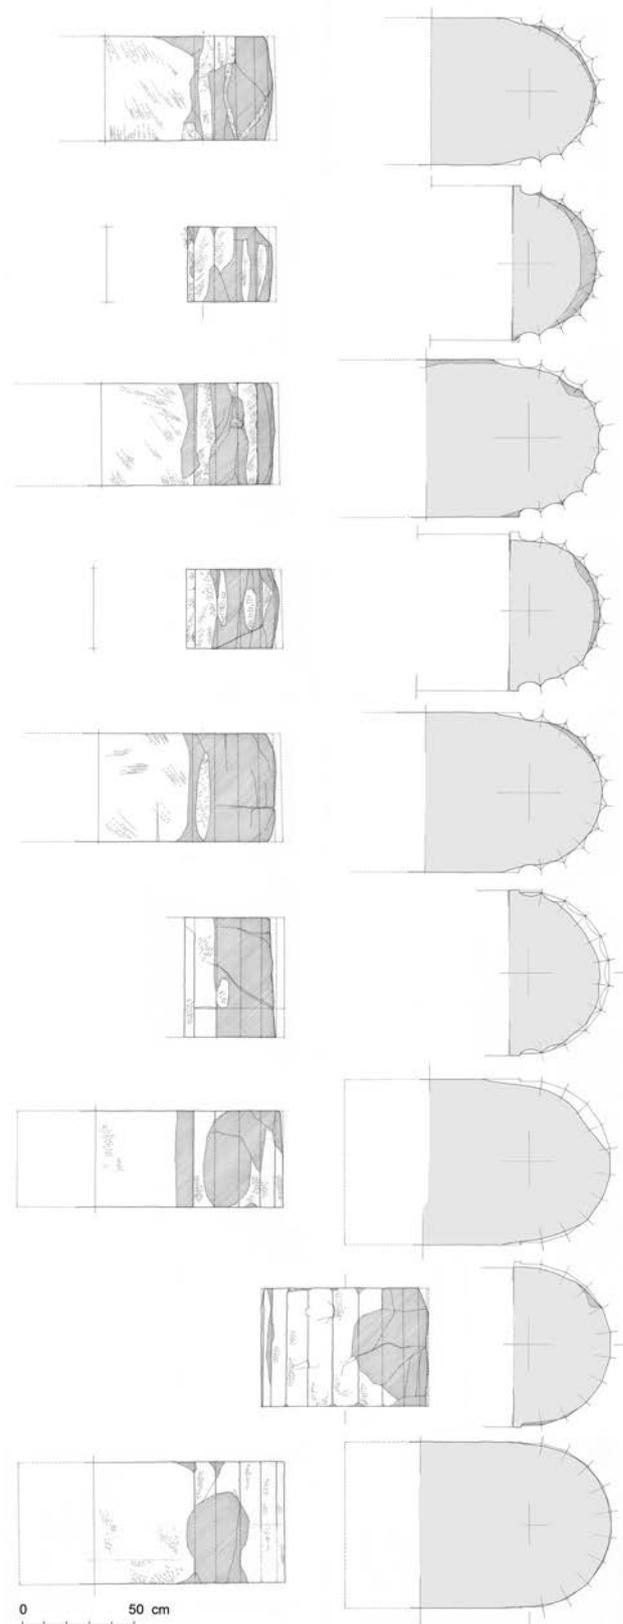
Navata centrale, semicolonna ND1, prospetto laterale e sezione orizzontale dei rocchi assalvo il II che presenta un prospetto frontale. Manca il X rocchio, asportato per l'inserimento dell'imposta dell'arco nel rifacimento del colonnato a seguito dell'incendio.
